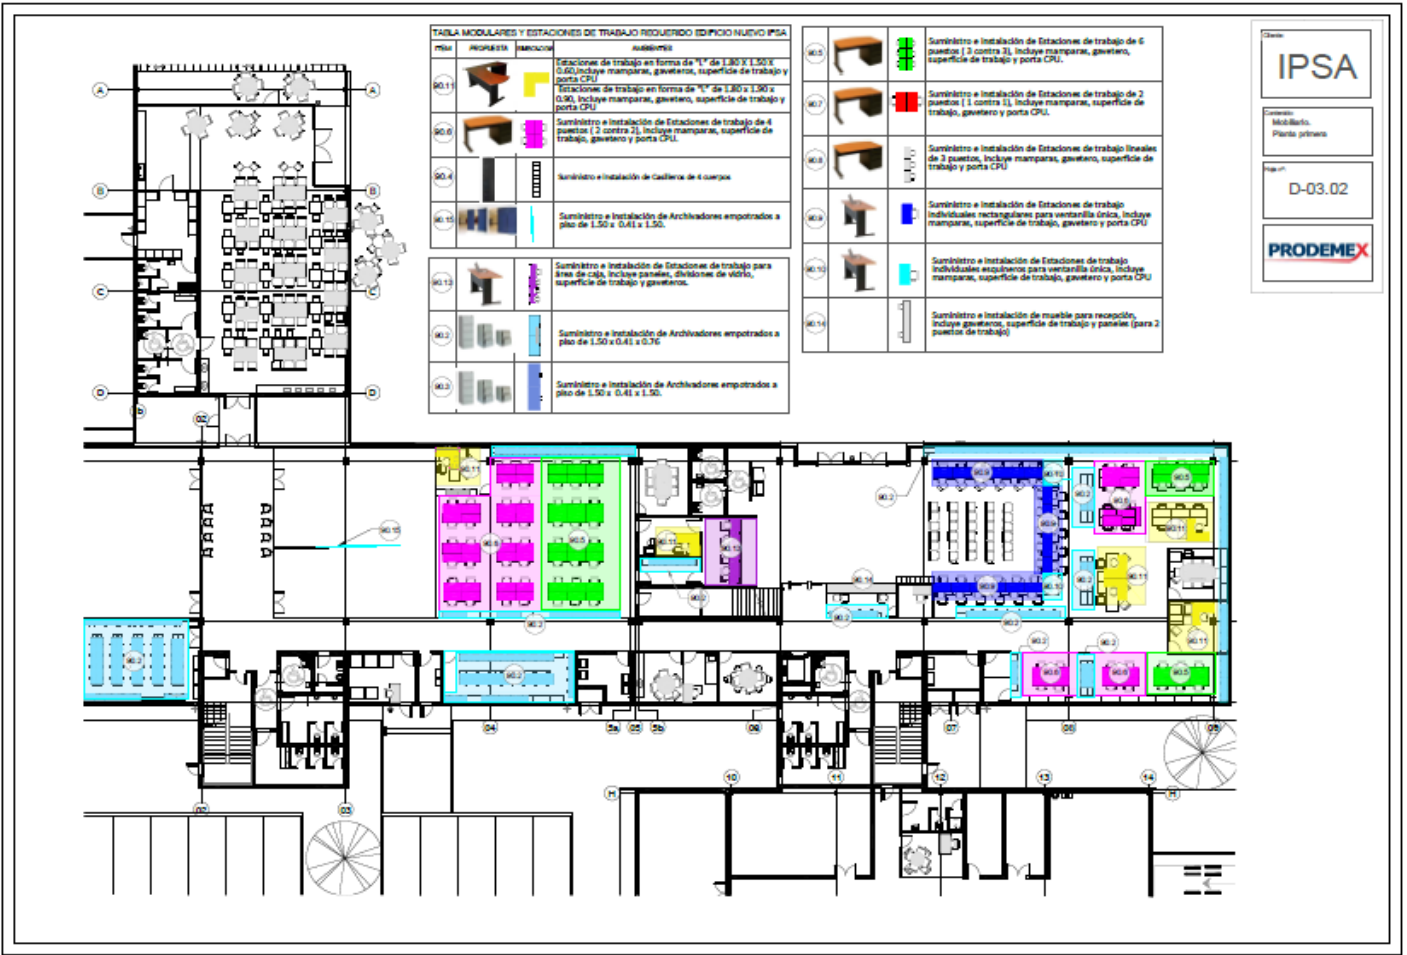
Lamina planta arquitectónica de muebles 2da planta
